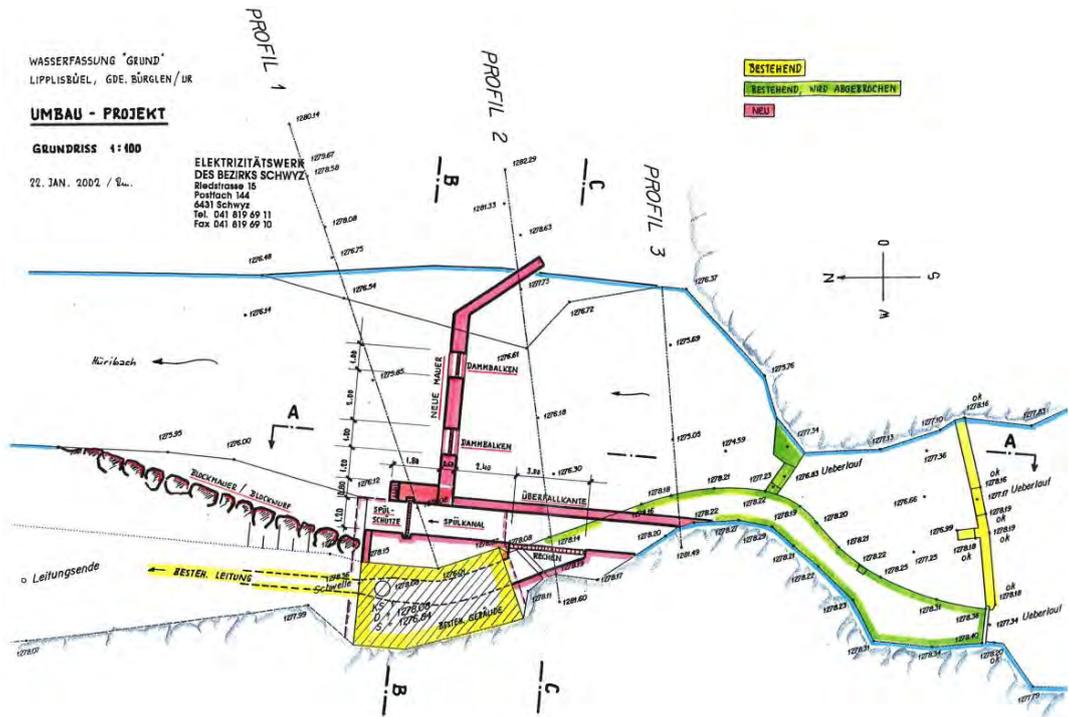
Grundriss der geplanten Fassung Grund (ebs Energie AG).
